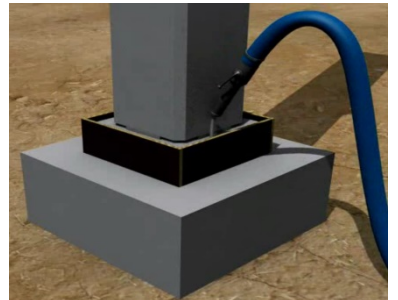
Proceso montaje pilar, Ref. PEIKKO
